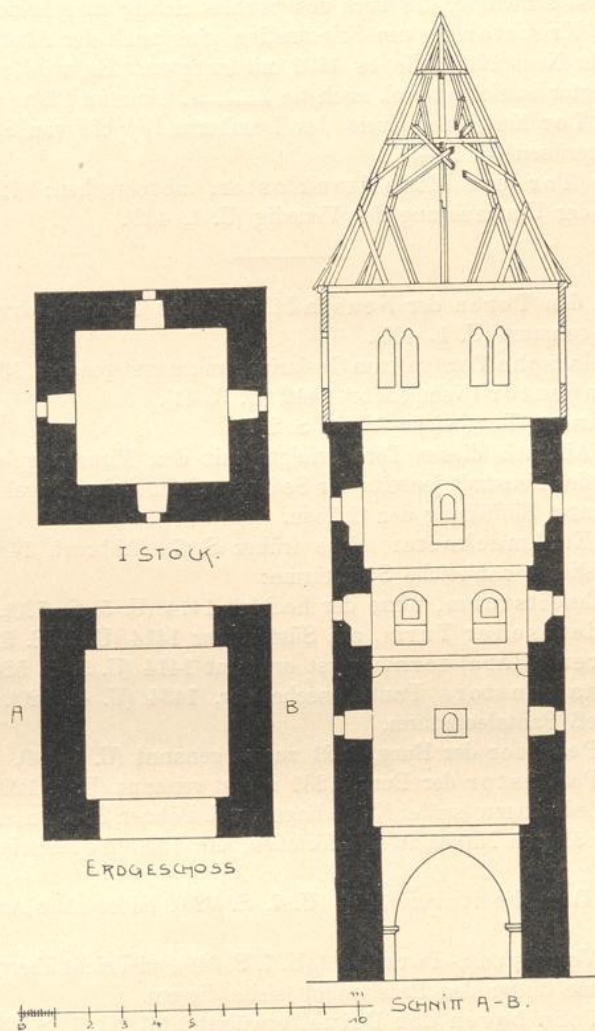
Kehrriederturm; Grundriß und Schnitt.
